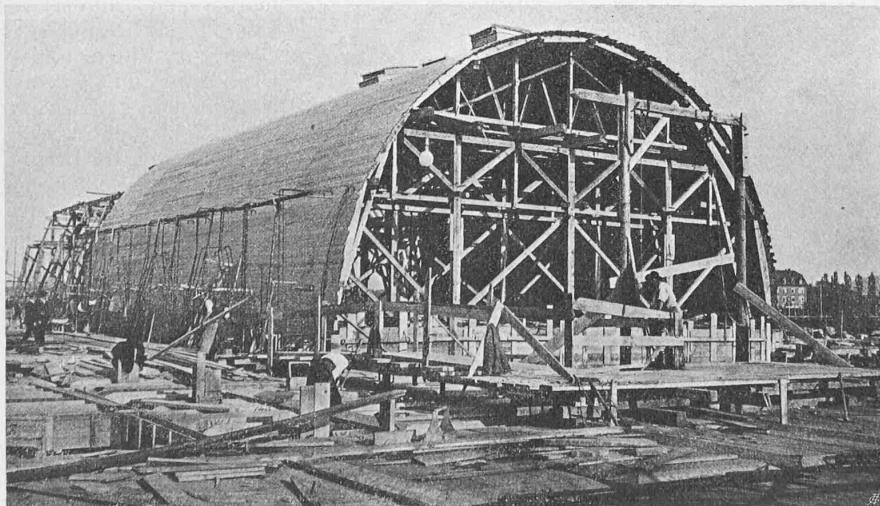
Hallengerüst in Höhe der Erdgeschossdecke.
